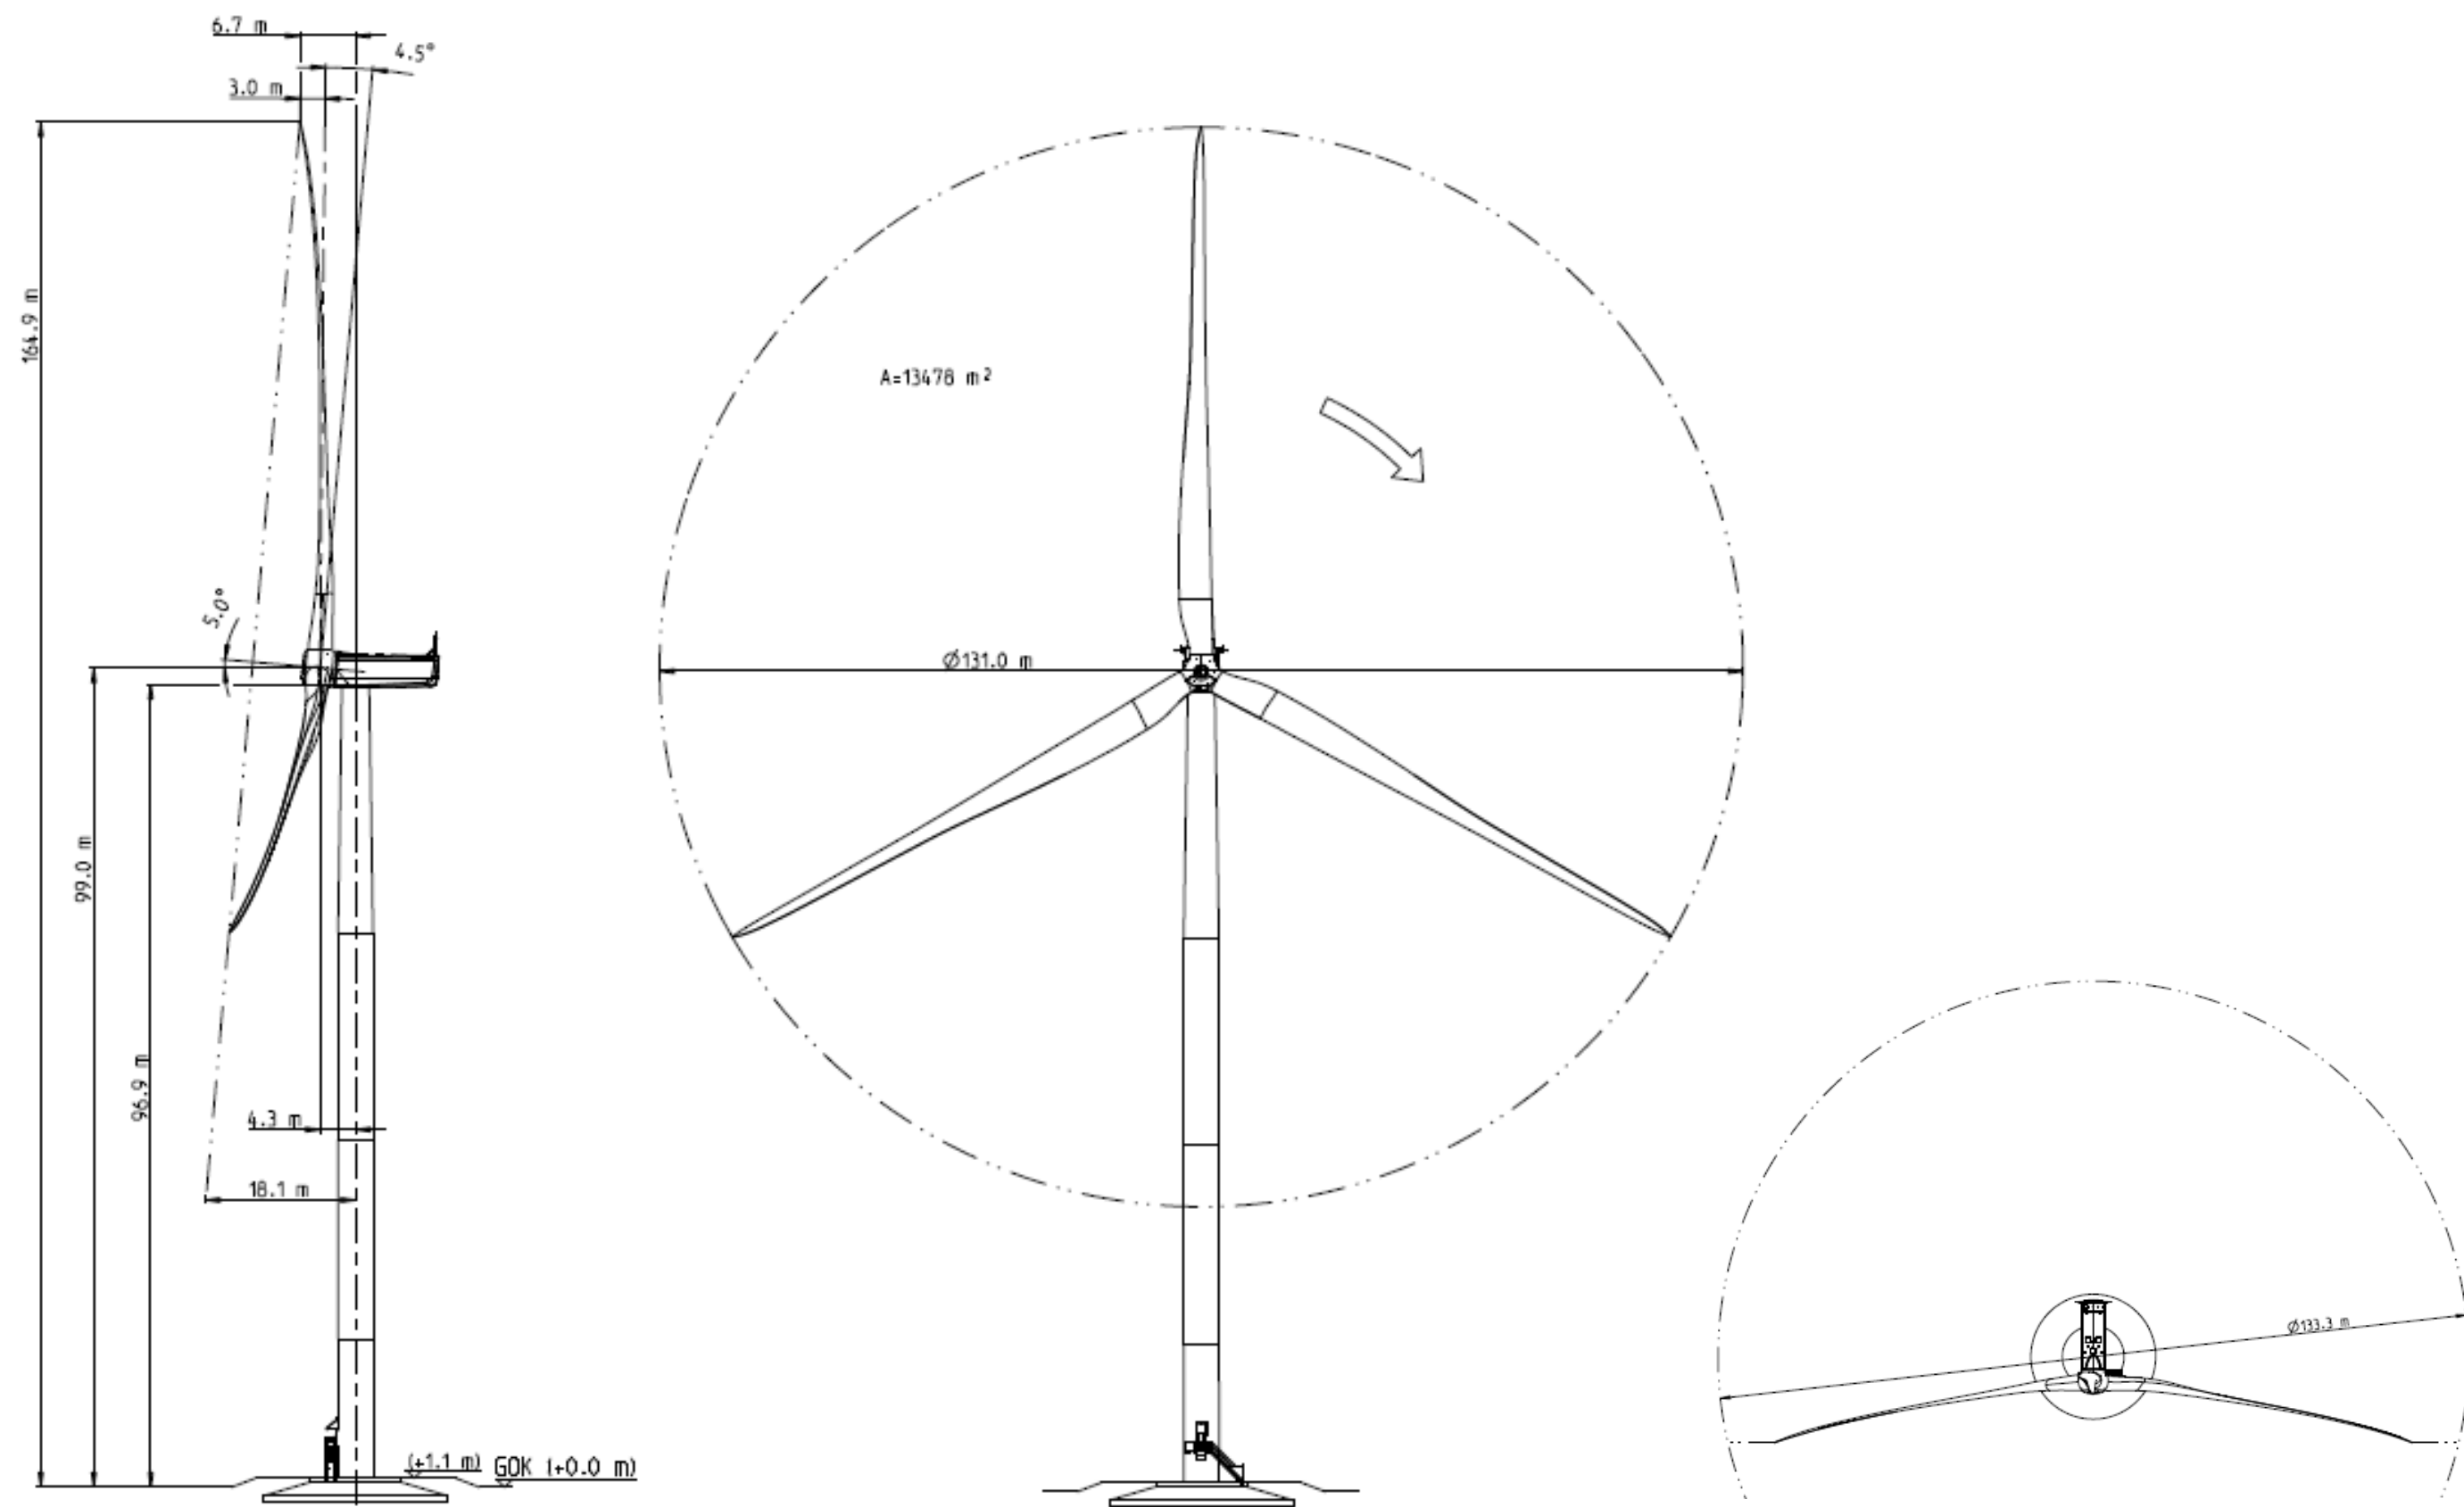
Plan d'élévation d'une éolienne N131 – 3,6 MW – 165m
